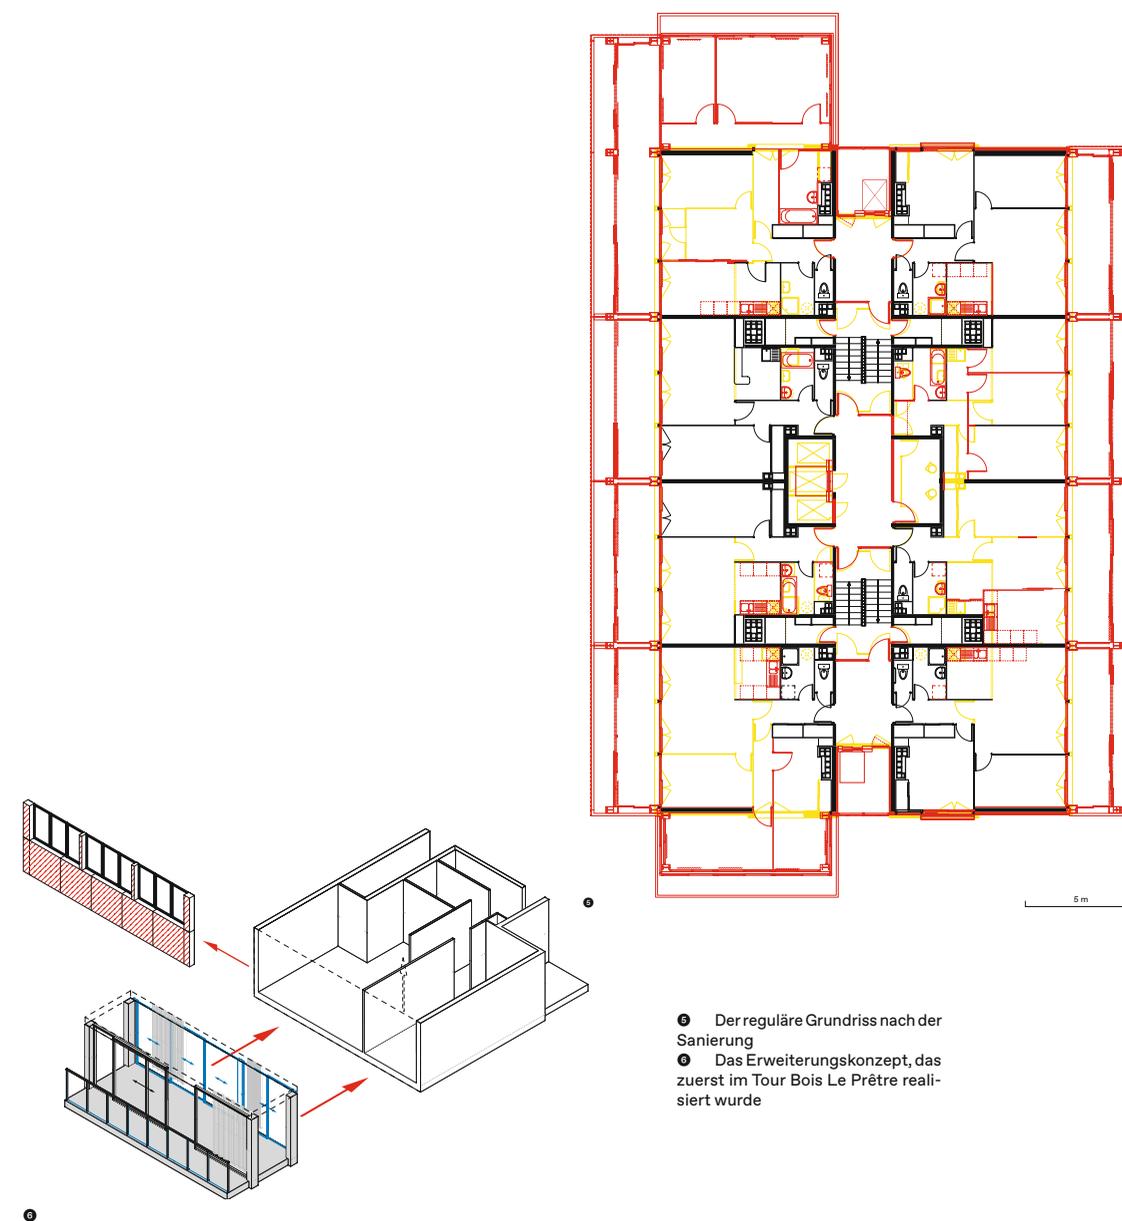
Grundriss mit Neubau und Abbruch/Erweiterungskonzept
